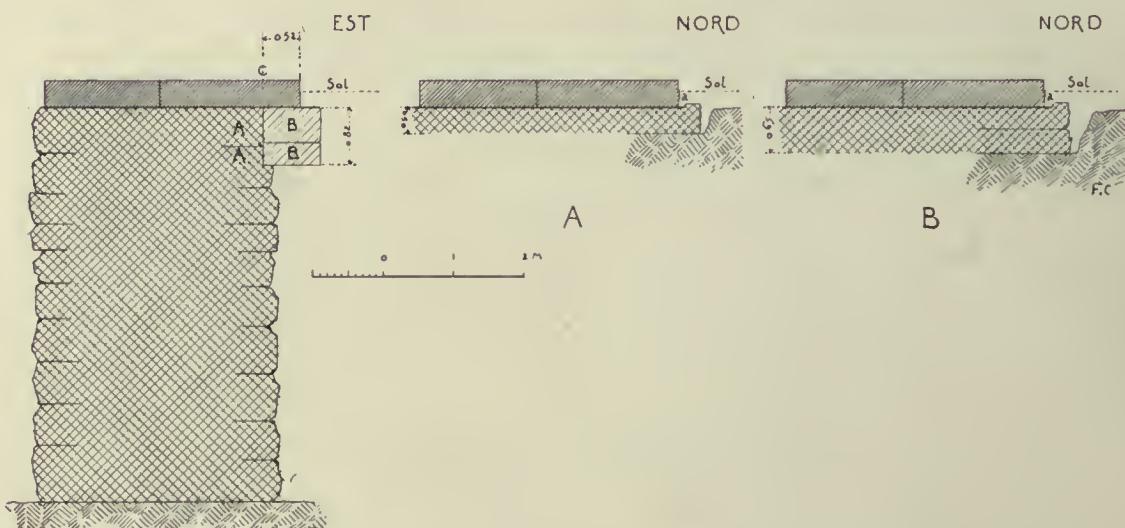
Coupe sur la fondation du côté Est (état actuel).
